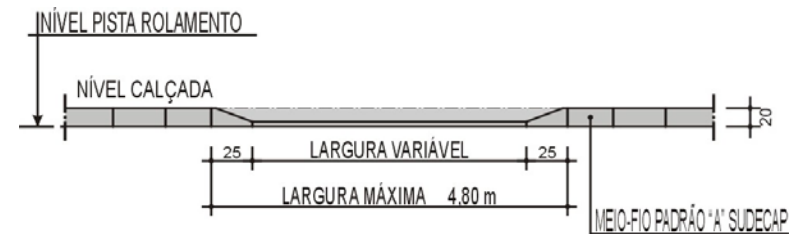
Elevação do rebaixo padrão para acesso de troca de óleo e lavagem.
